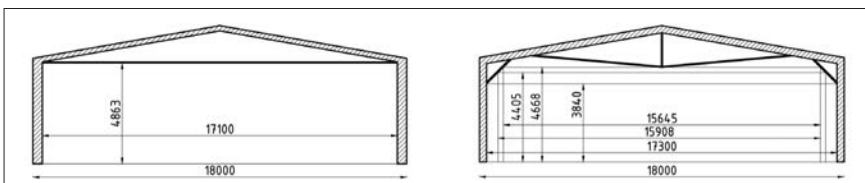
Schemat układu konstrukcyjnego projektowanego na „stałą siłę”
